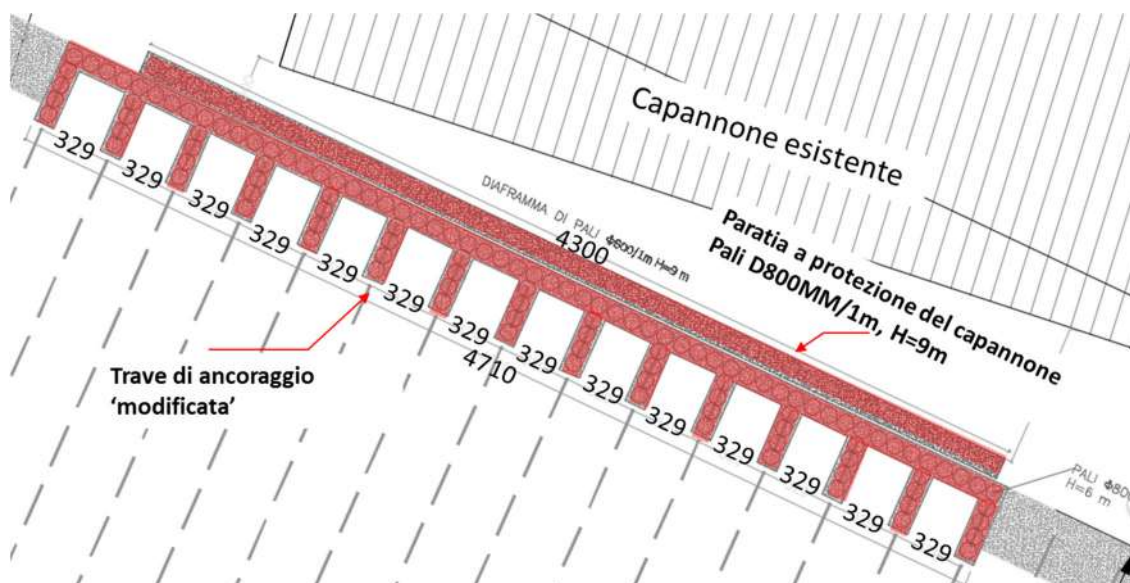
Planimetria della trave di contrasto in prossimità del capannone: si osserva la paratia a protezione dell'edificio e la trave di contrasto modificata, realizzata con pali secanti e affiancati
